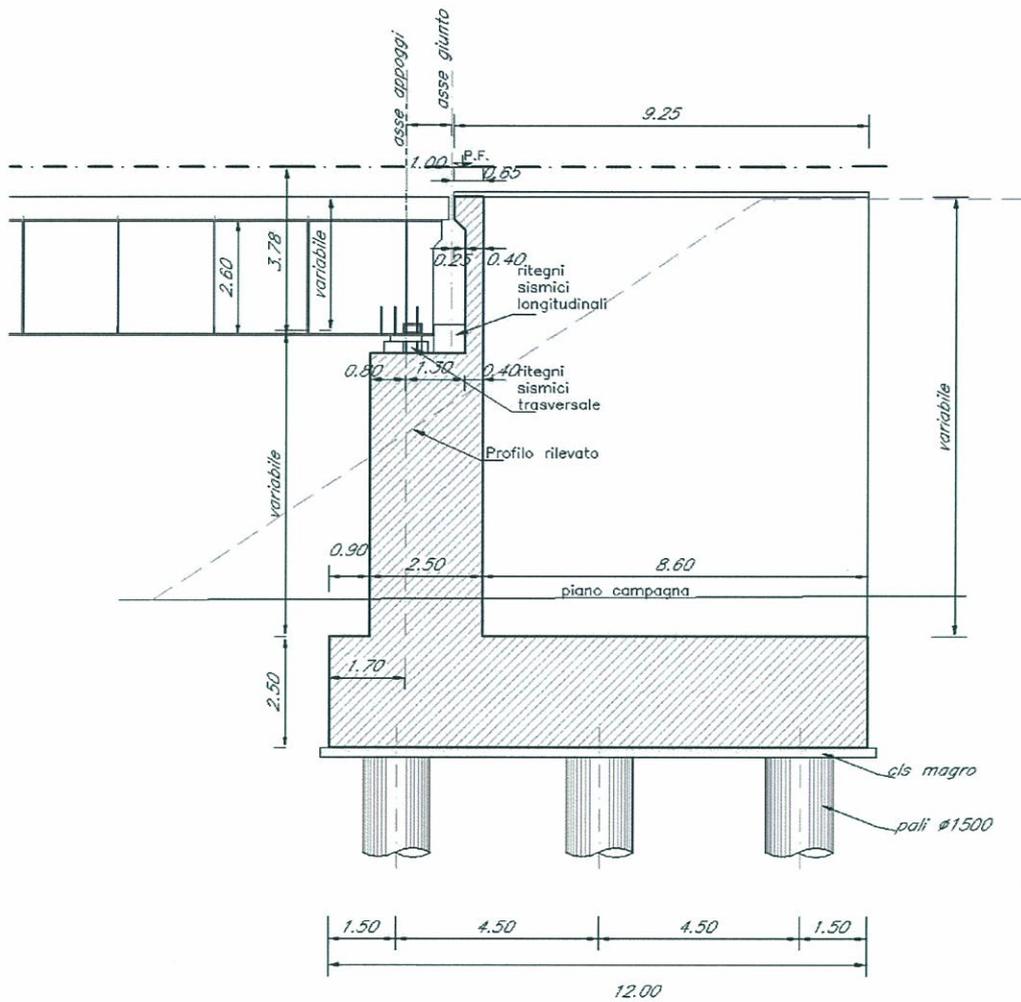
Sezione longitudinale della spalla tipo.
